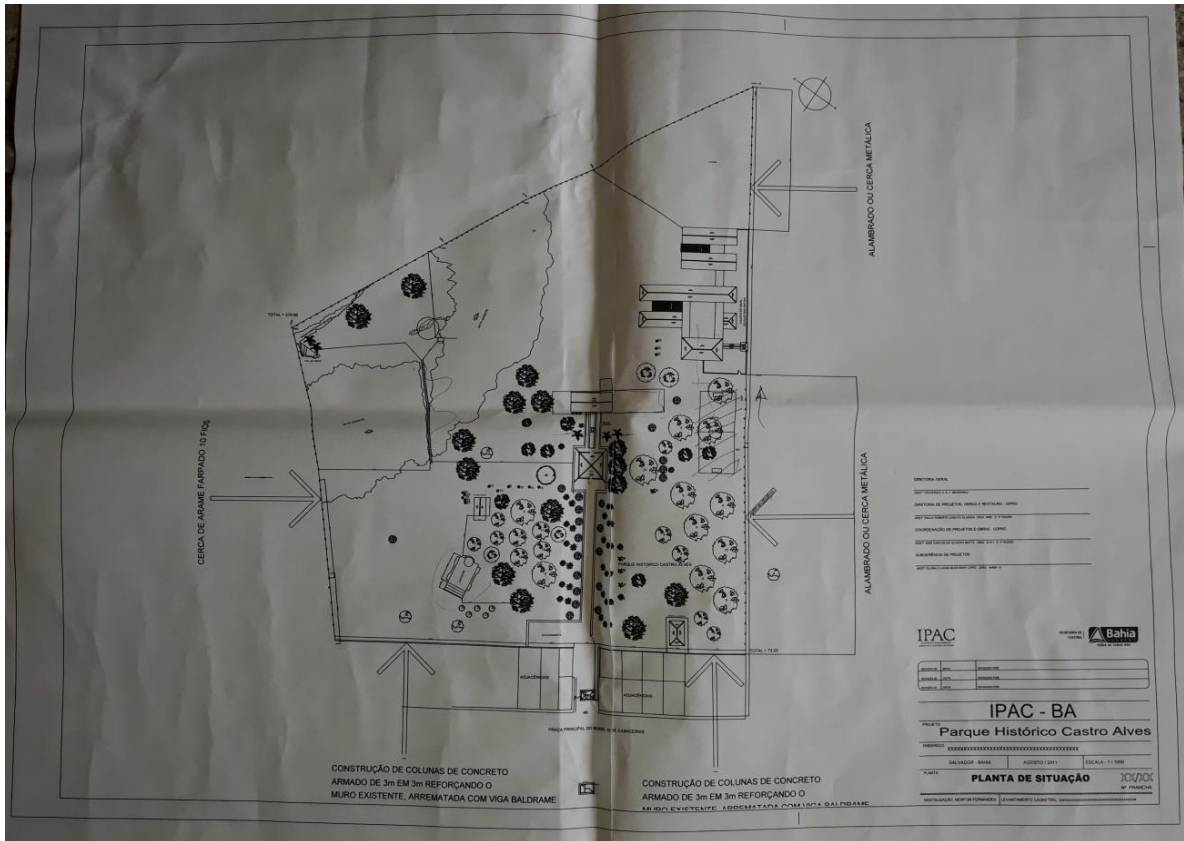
Planta de Situação. Fonte: IPAC, 2011.
